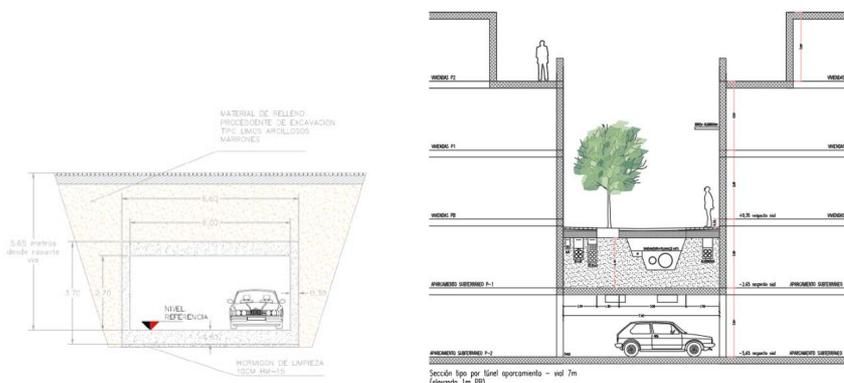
Limitación perfil vial por estructura conexión de sótanos
